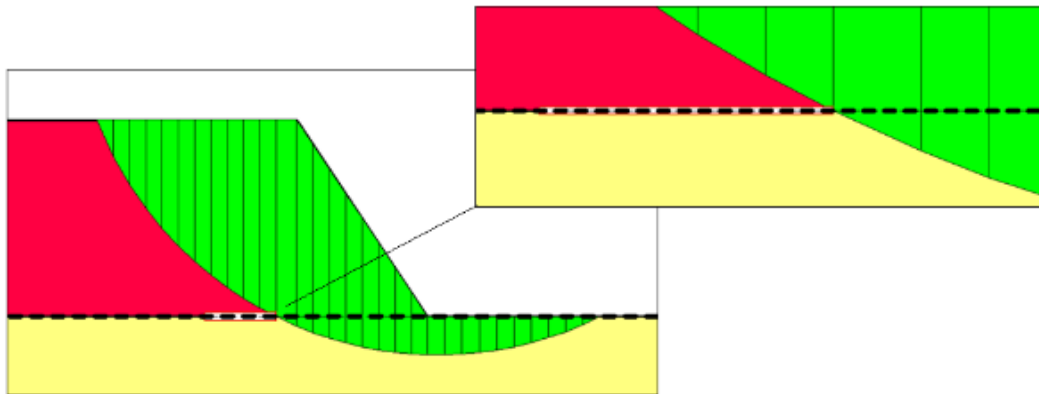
Deslizamiento más desfavorable para el terraplén reforzado con geomalla y longitud requerida del refuerzo.
